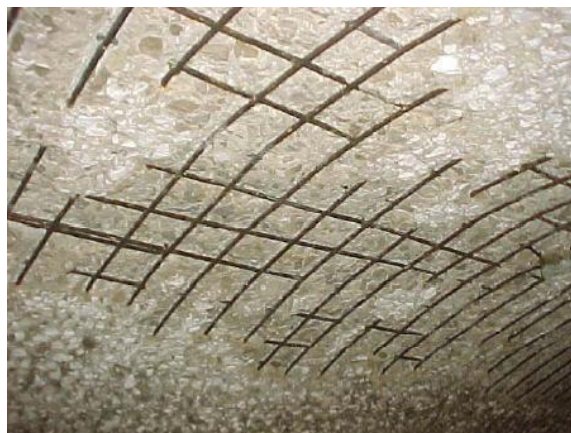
Fissuração e delaminação do betão devido à corrosão das armaduras, (Lucio 2007).
